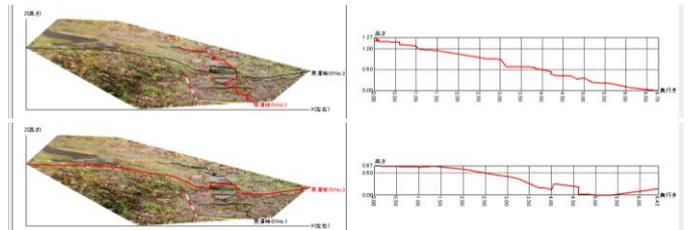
黒沢峠の石畳み街道の縦断面図と横断面図
